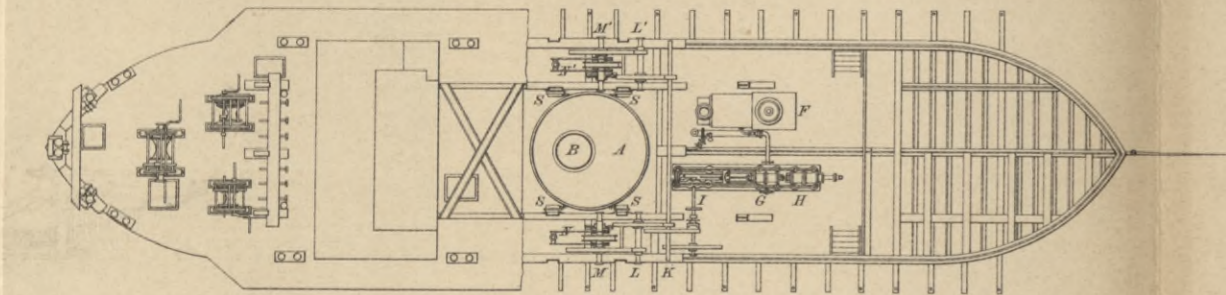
Grundriss Arbeitskammer M. 1:50.
